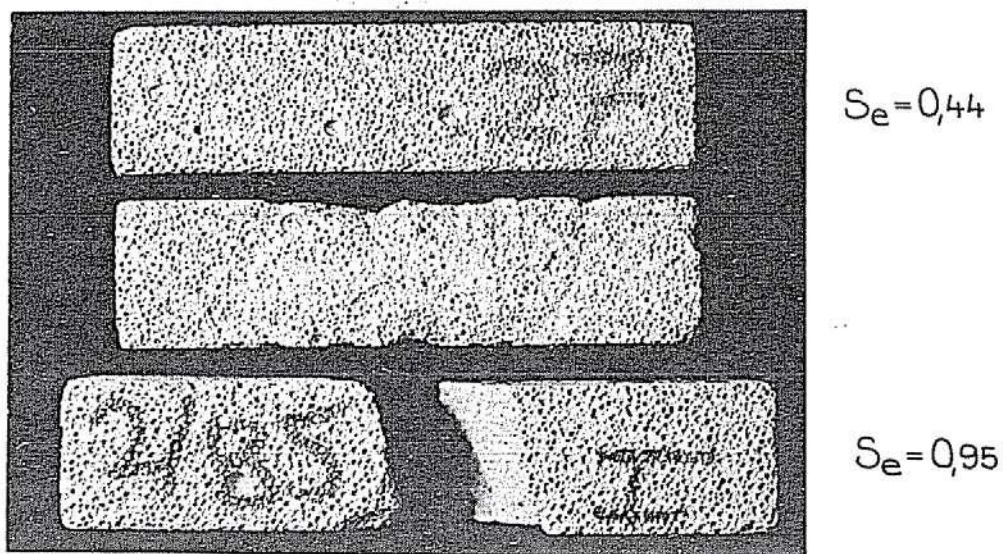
Material nr 9. Gasbetong typ 2. Oskadade och skadade provkroppar. Cellular concrete type 2. Intact and damaged specimens.
